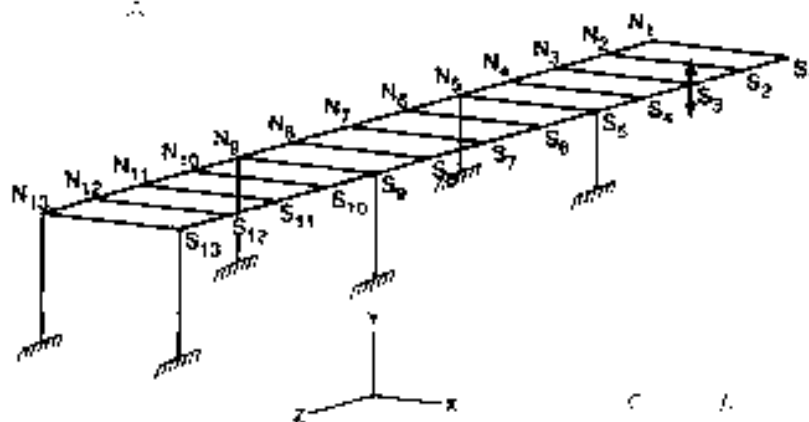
Modelos de vigas en puentes (www.construaprende.com).
